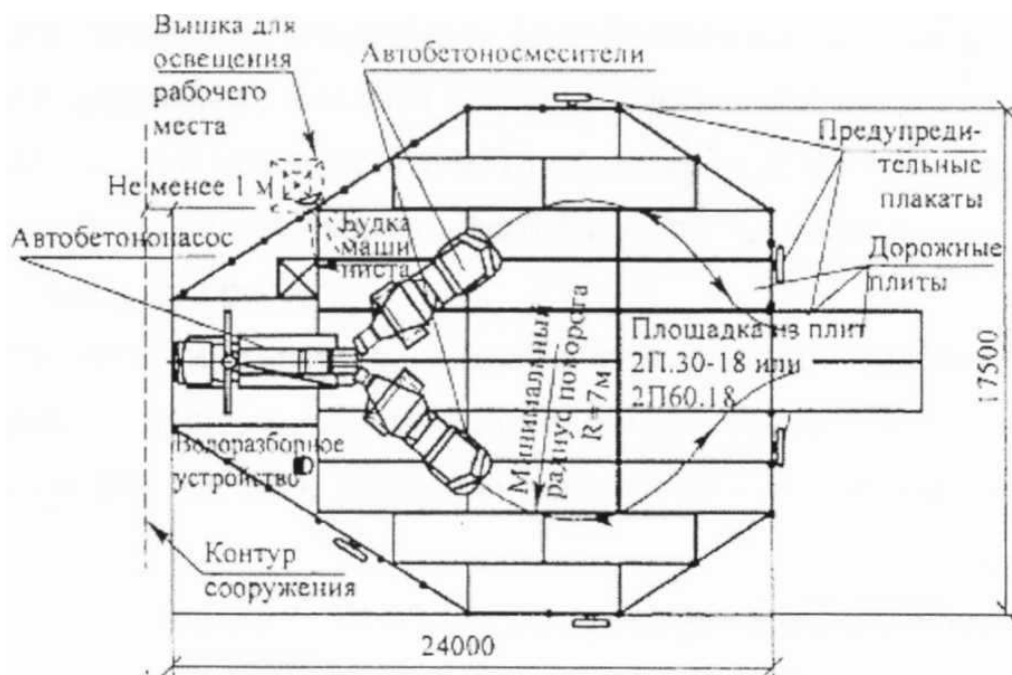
Схема размещения комплекта машин при производстве бетонных работ на объекте
